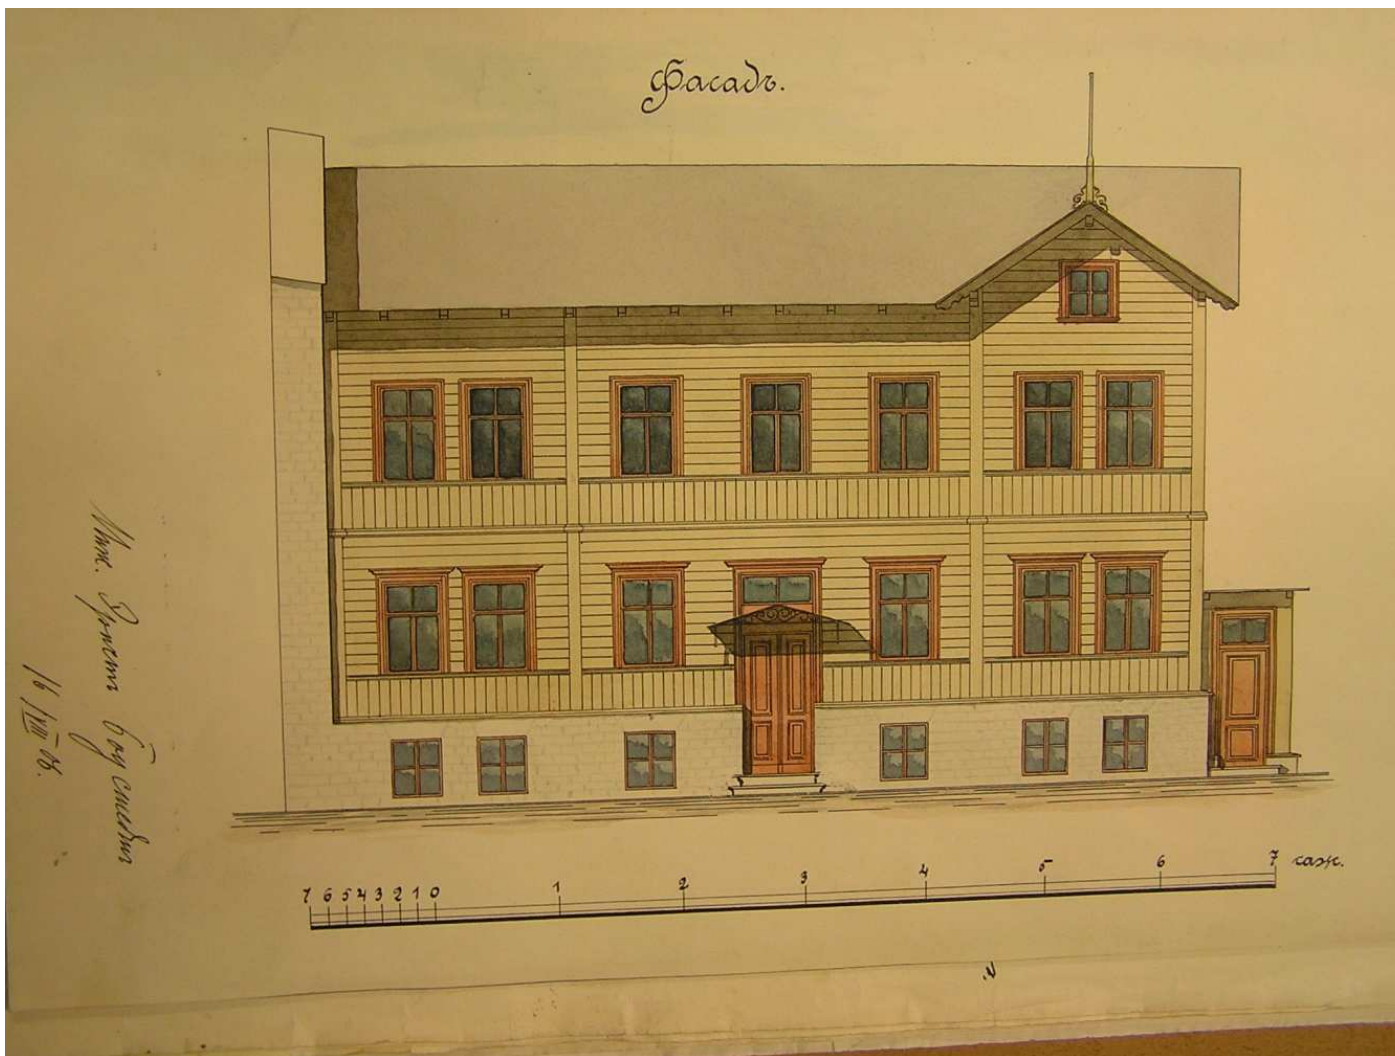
hoone vaade põhjas, 1906. a – foto arhiividokumendist.
